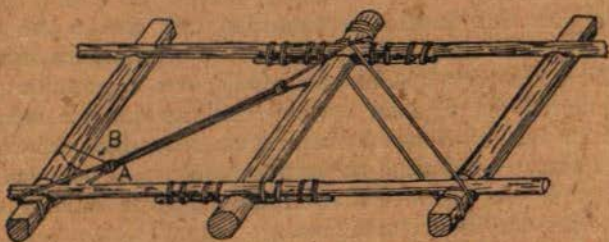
Contraventamento em cabo metálico da armação inferior.
